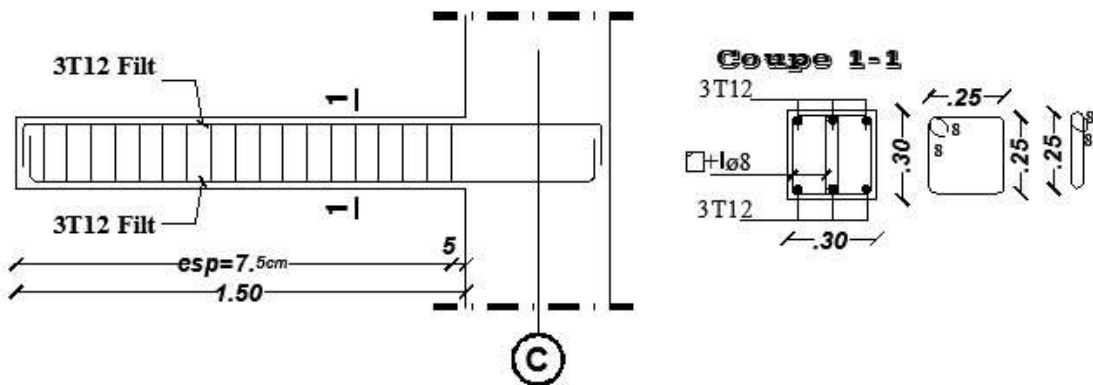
Coffrage et ferrailage de poutre palière
